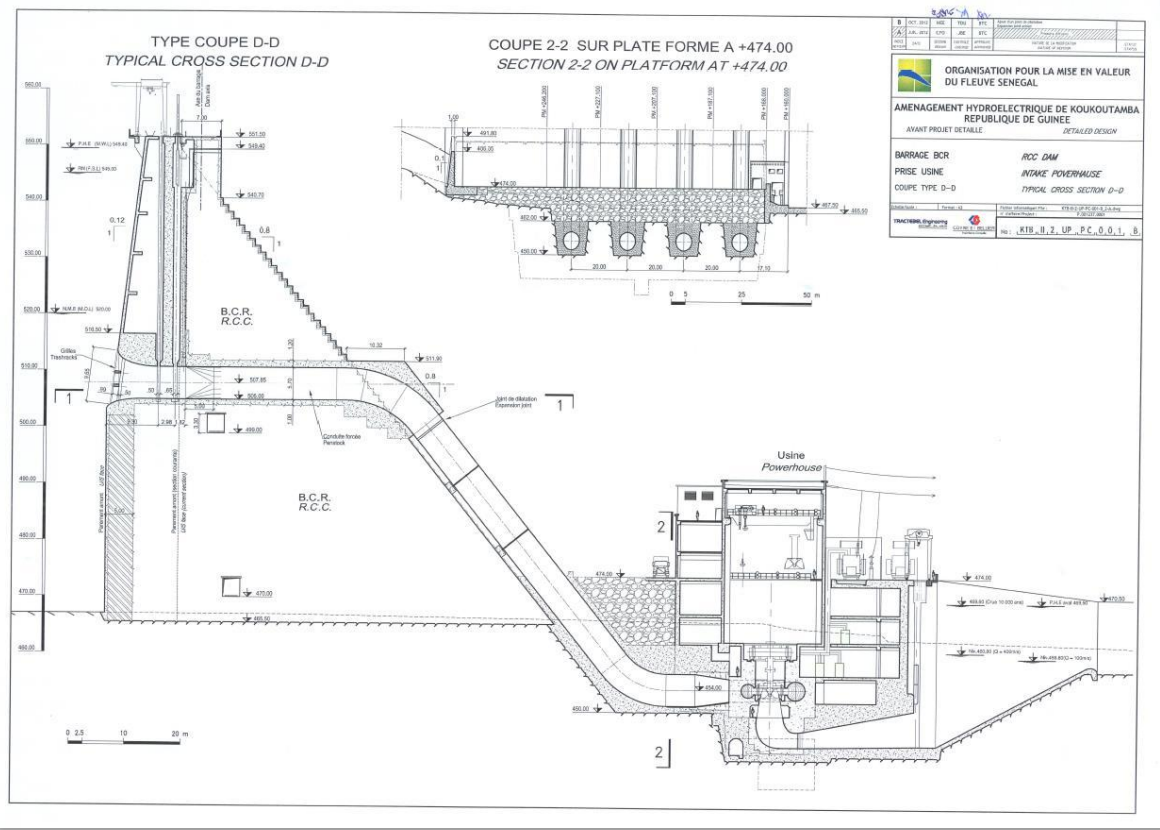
Coupe-type prises usinières du barrage de Koukoutamba
